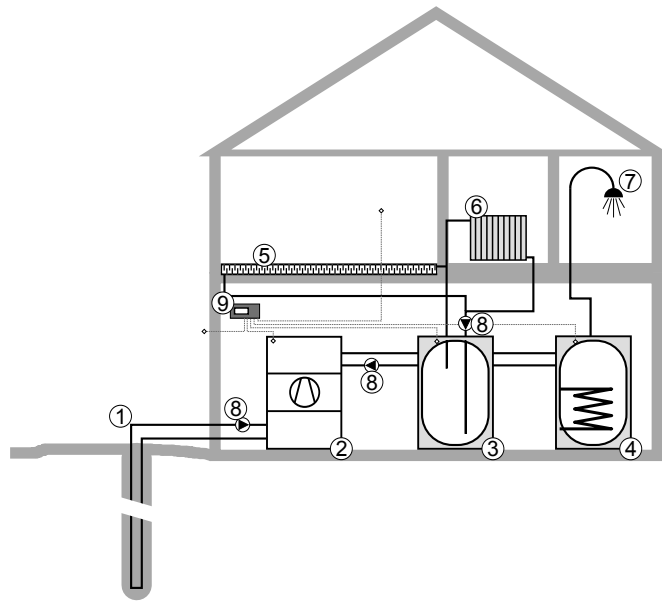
Schematische Darstellung einer Wärmepumpenheizung mit den zentralen Komponenten: 1=Wärmequelle (Erdsonde); 2=Wärmepumpe; Speicher (3=Heizung; 4=Trinkwasser); Wärmeabgabesystem (5=Fussbodenheizung; 6=Radiator); 7=Zapfstelle Trinkwasser; 8=Sekundärpumpen; 9=Systemregler
